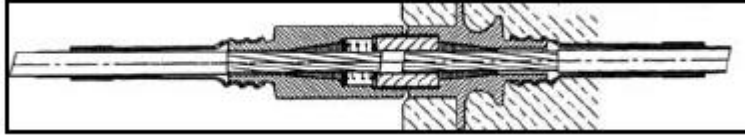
b. Diseño de acoplador fijo. [B1]
